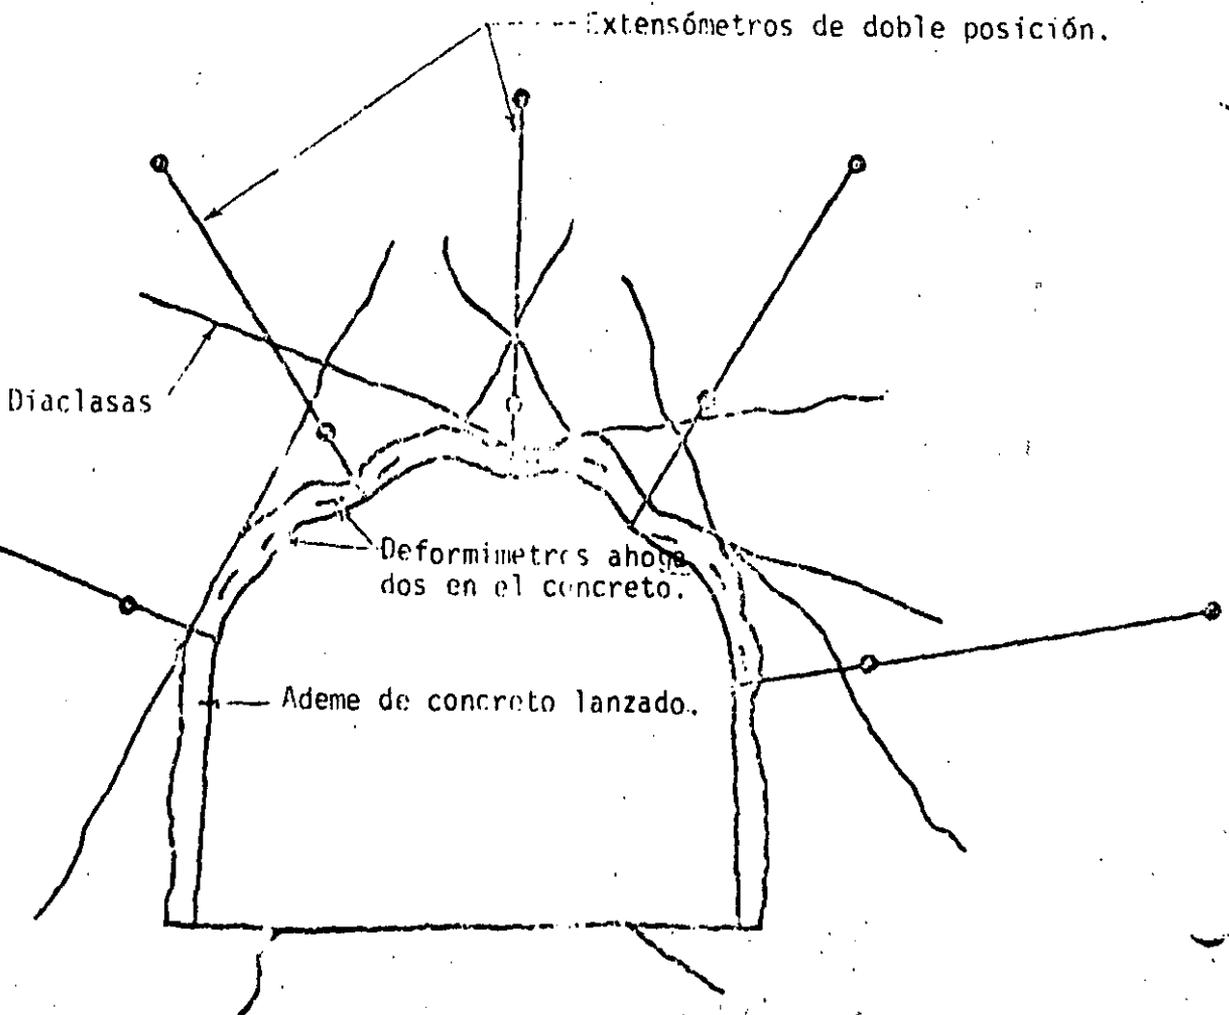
B. Instrumentación para un túnel ademado con concreto lanzado.
